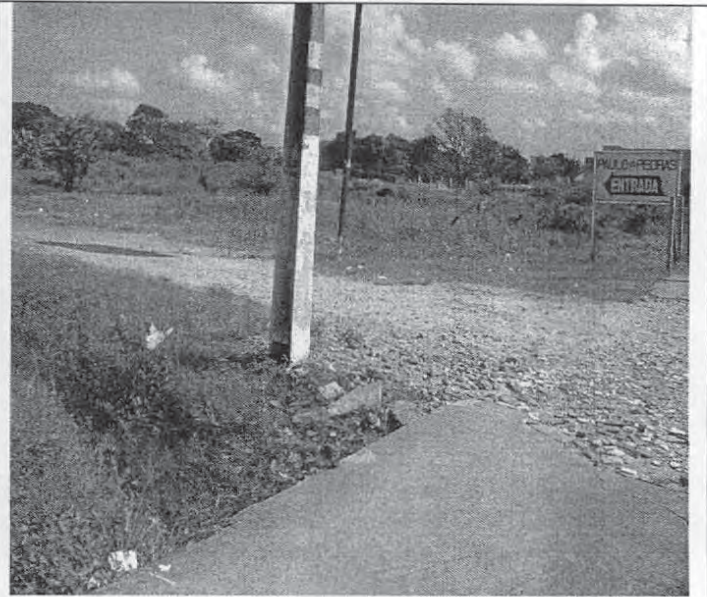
Trecho da Lagoa do Carrapicho que foi aterrado
